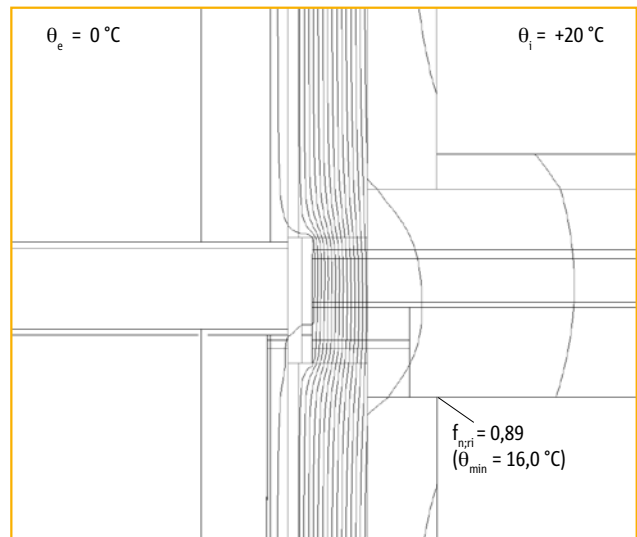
Aansluiting terrasplaat met Schöck Isokorb® type K50
